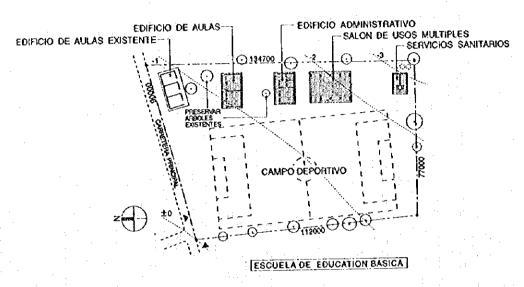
PLAN GENERAL DE DISPOSICION DEL INSTITUTO NACIONAL DE SESORI
